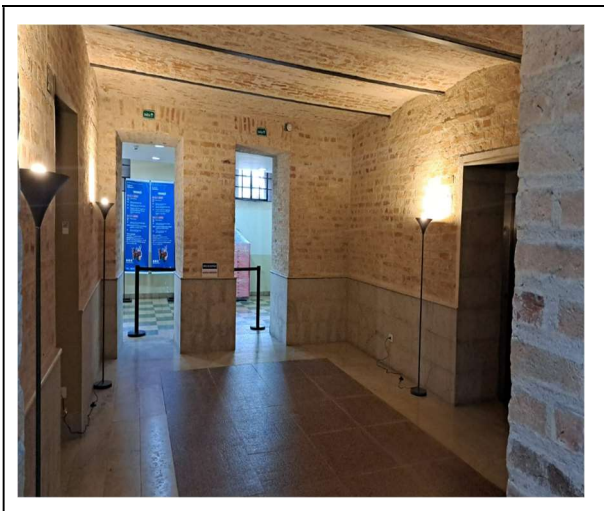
Implantação de iluminação para acesso ao pavimento inferior, hall elevadores.
